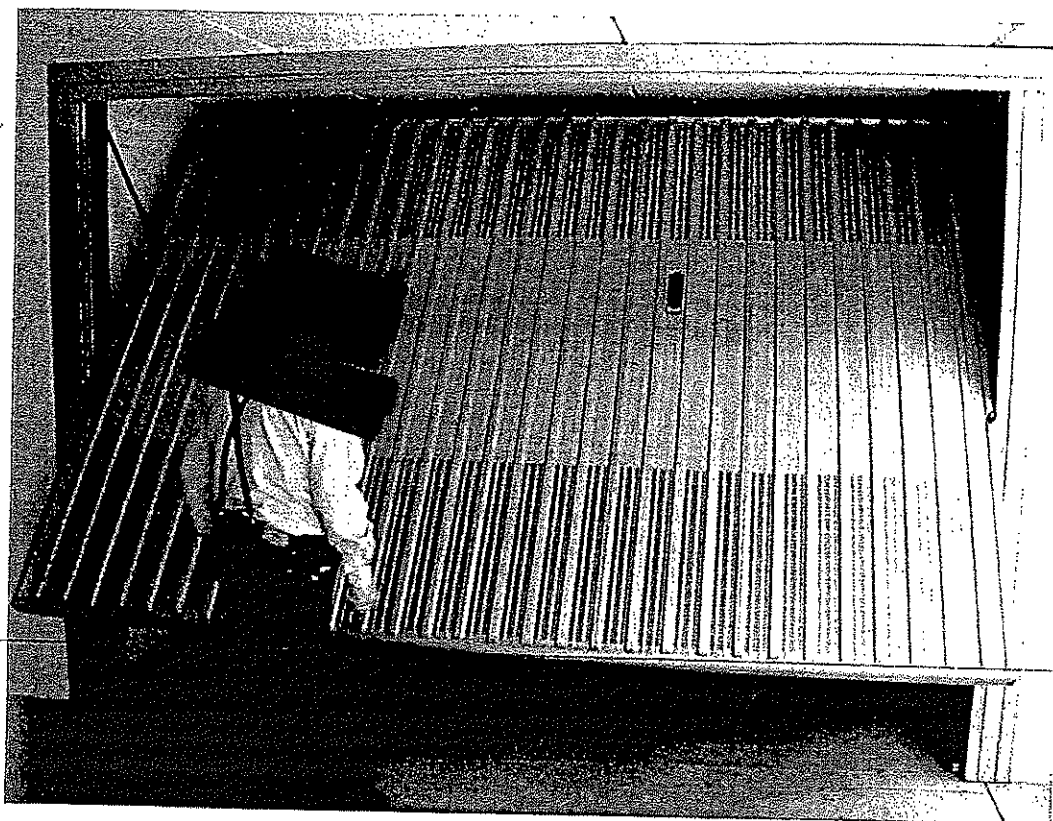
Vista del portone basculante di accesso all'autorimessa di cui al M.N. 1098 sub 54.
